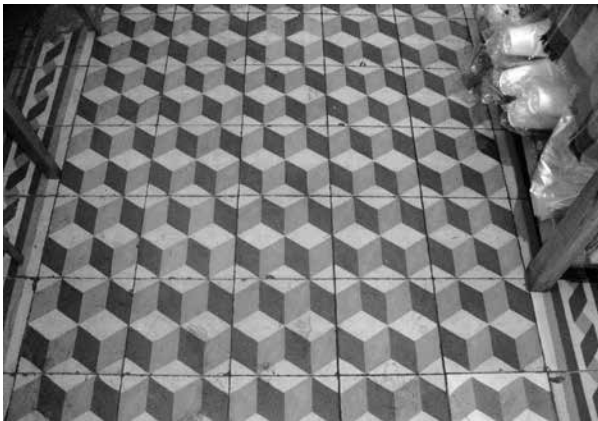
Pavimento de la casa de Zacatecas, Zacatecas. Fotografía de Enrique Tovar.
